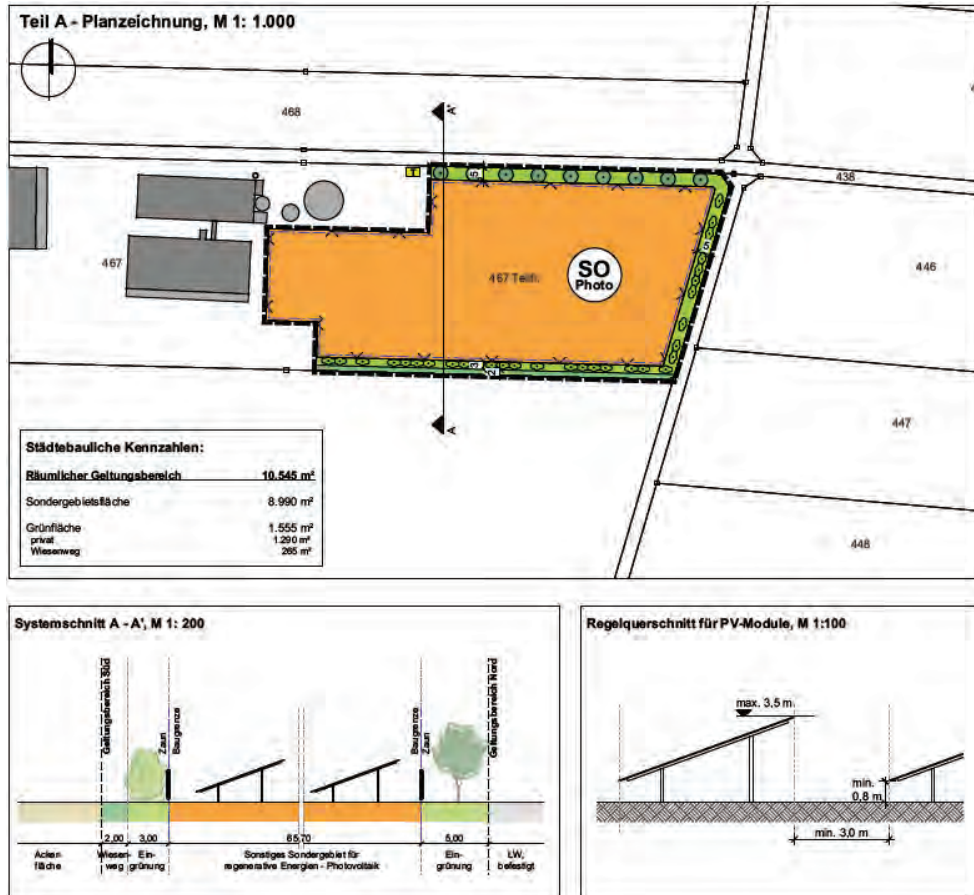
Ausschnitt Planzeichnung B-Plan „Solarpark Pessenburgheim Raba“
